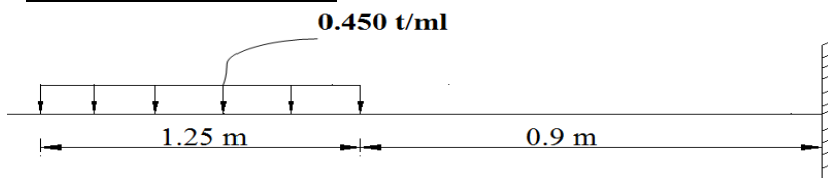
Surcharge de trottoir sur la dalle d'encorbellement
